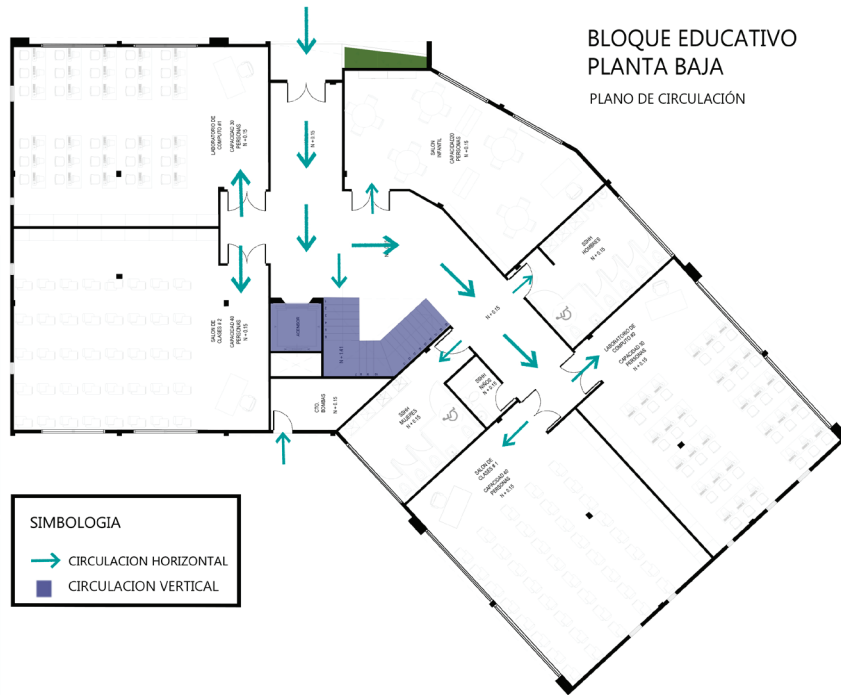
Plano de circulación- Bloque educativo - Planta Baja; Fuente: Elaboración Propia.
